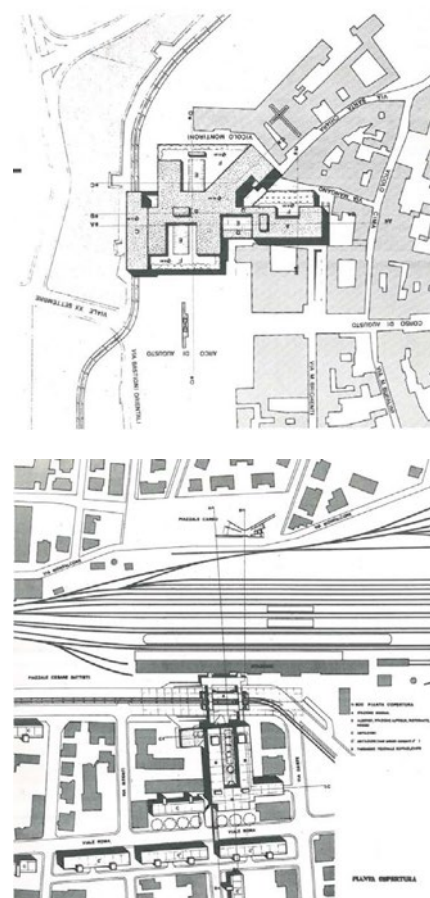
Planimetria del Condensatore collocato presso l'arco di Augusto.
